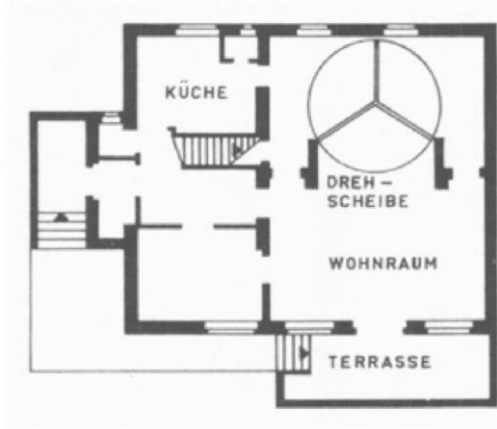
Erich Mendelson, Planta de su Villa flexible, 1923
